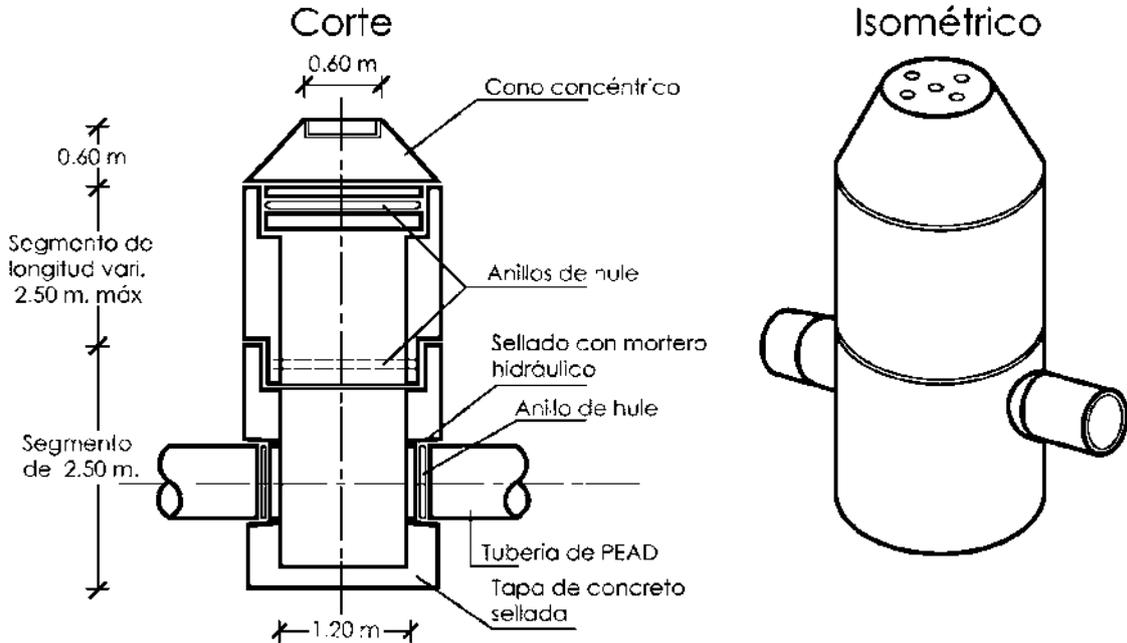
Detalle del pozo de visita prefabricado. Imagen: Sajid G.
